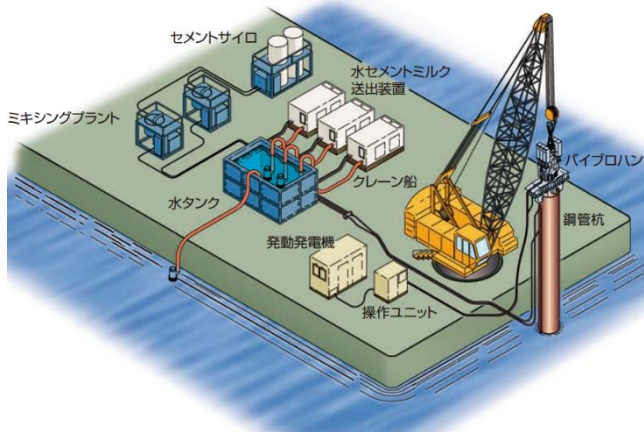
設備配置図 (出典 [5.10-27](#))
